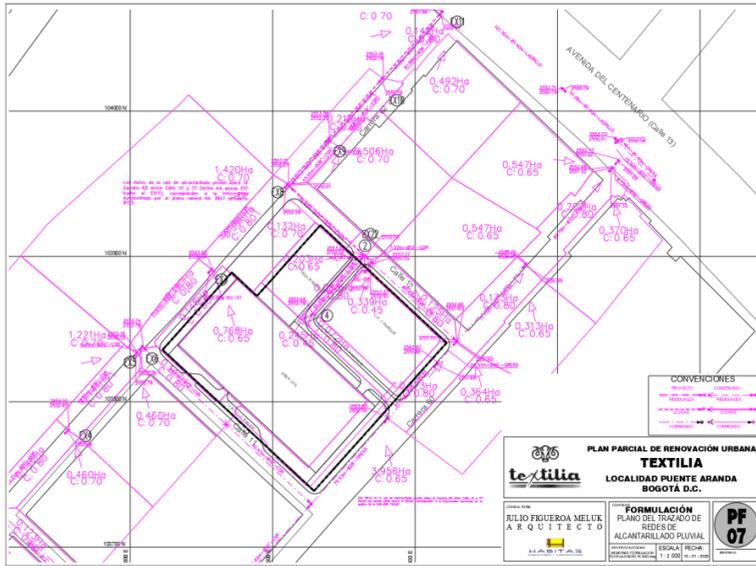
Plano PF-07 Trazado de Redes de Alcantarillado Pluvial
